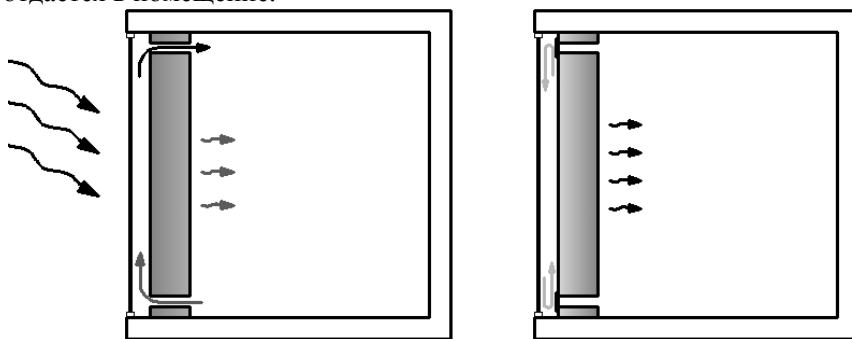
Схема работы стены Тромба с открытыми клапанами днем и закрытыми ночью.
